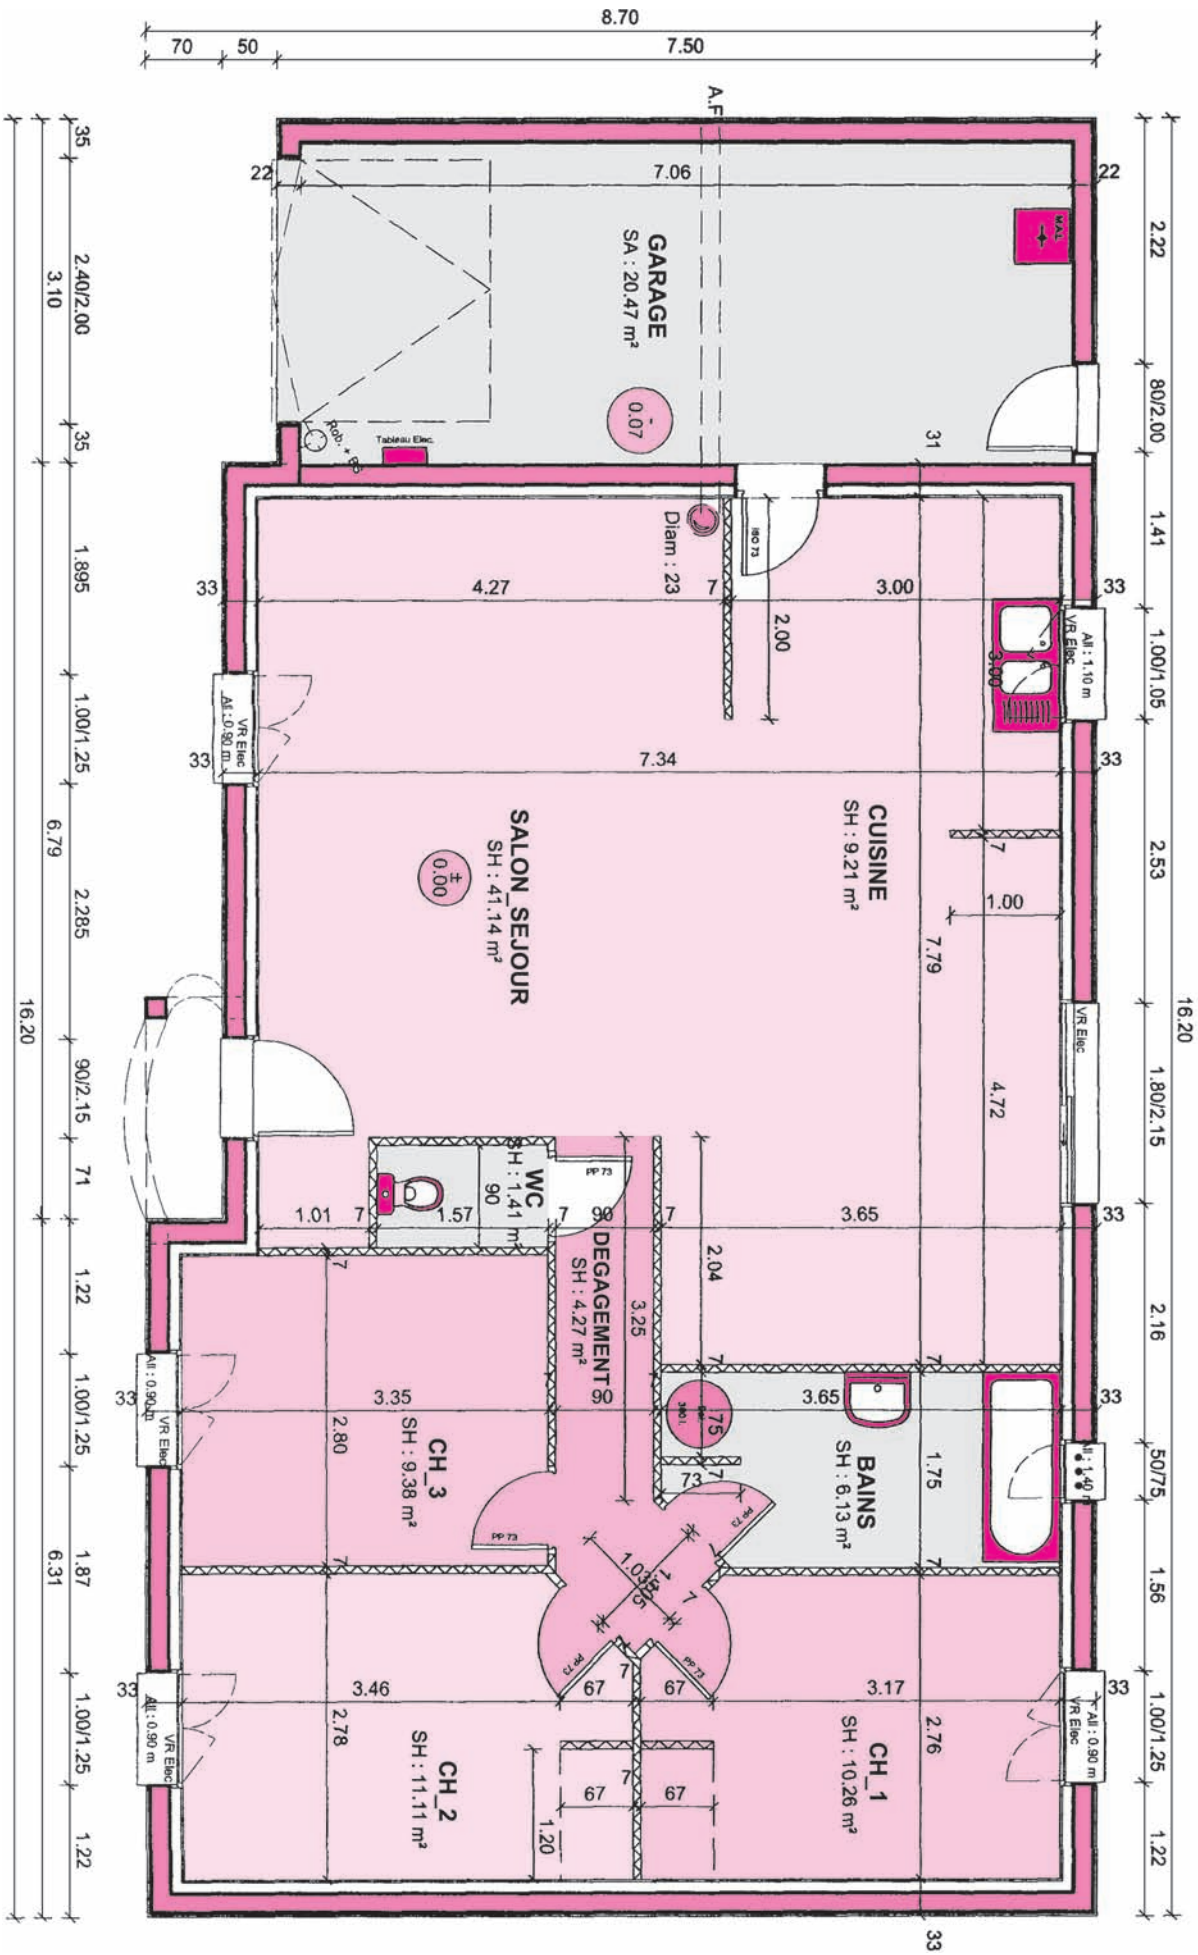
Plan du rez-de-chaussée avec cotes extérieures, intérieures et les niveaux des sols
